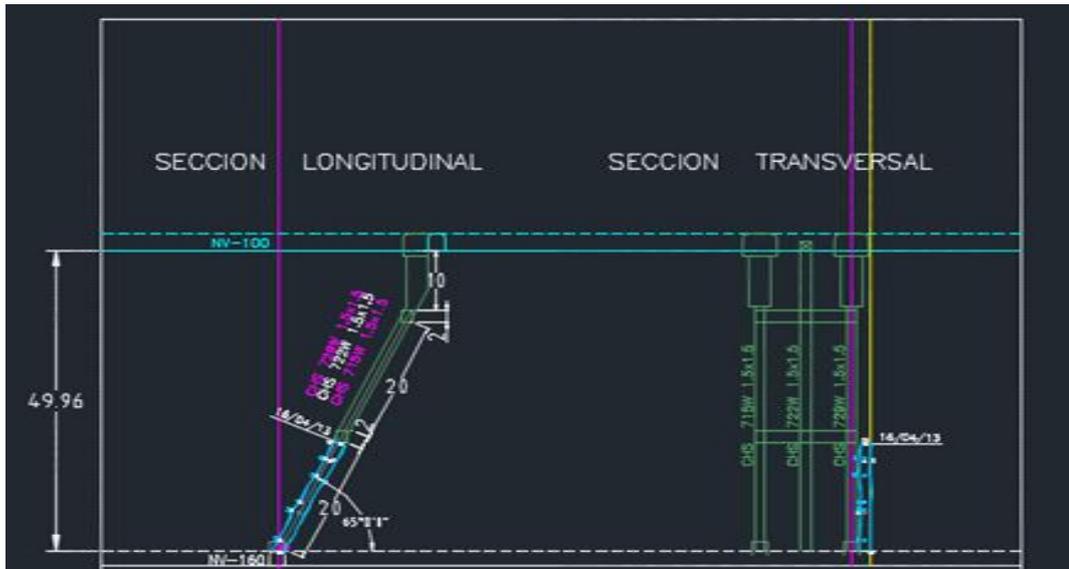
Sección Longitudinal e Transversal de Chimeneas Trillizas
